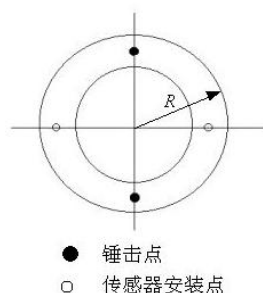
管桩传感器安装点（检测点）、锤击点布置示意图
